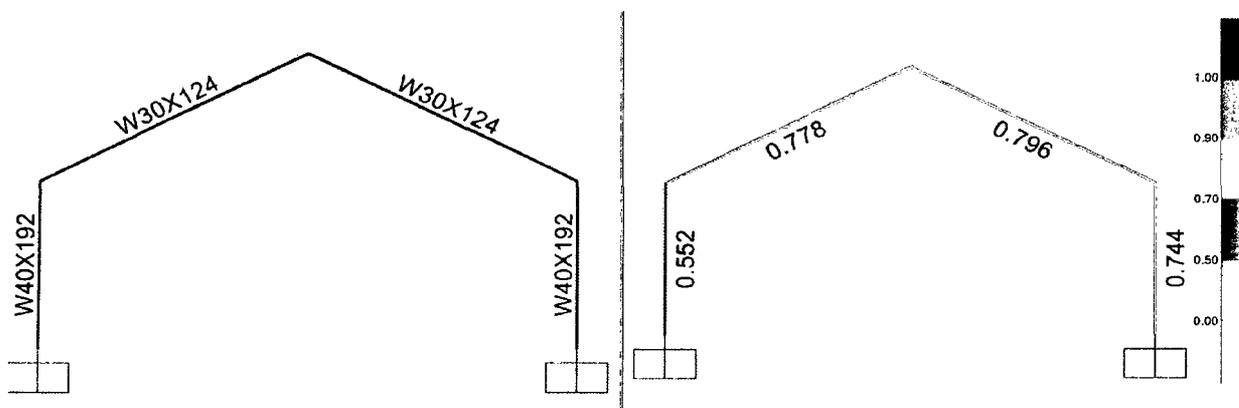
Pórtico Rígido de 30 m. de luz
